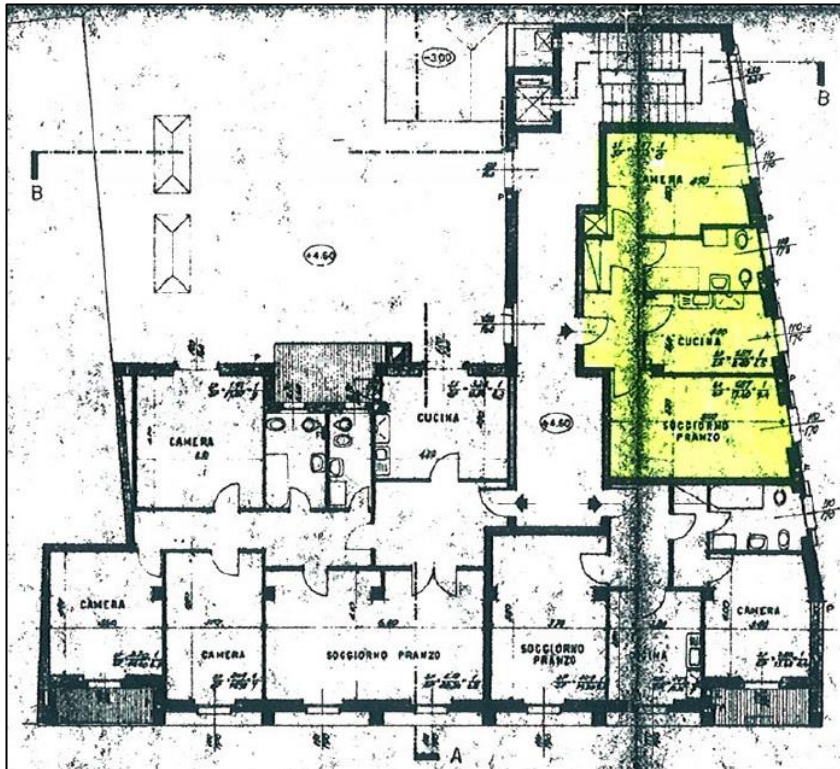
planimetria dell'unità immobiliare ad uso abitativo al piano 1°
